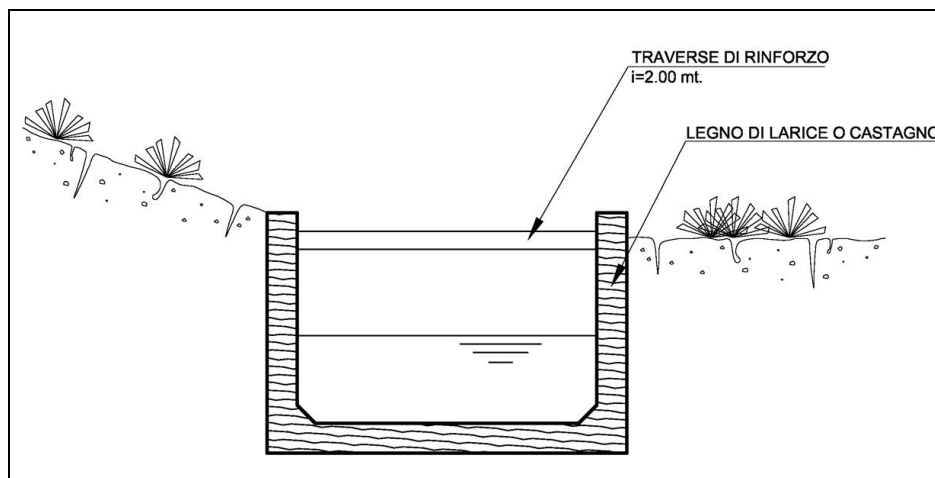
Compluvio centrale – Canaletta ad U in legname
